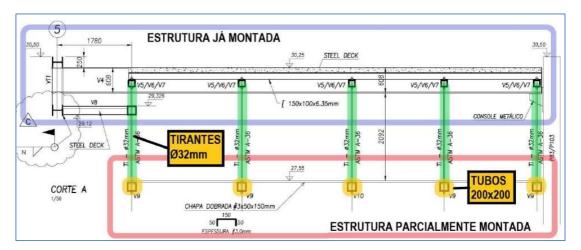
corte da estrutura do piso cenotécnico e da estrutura de laje.
